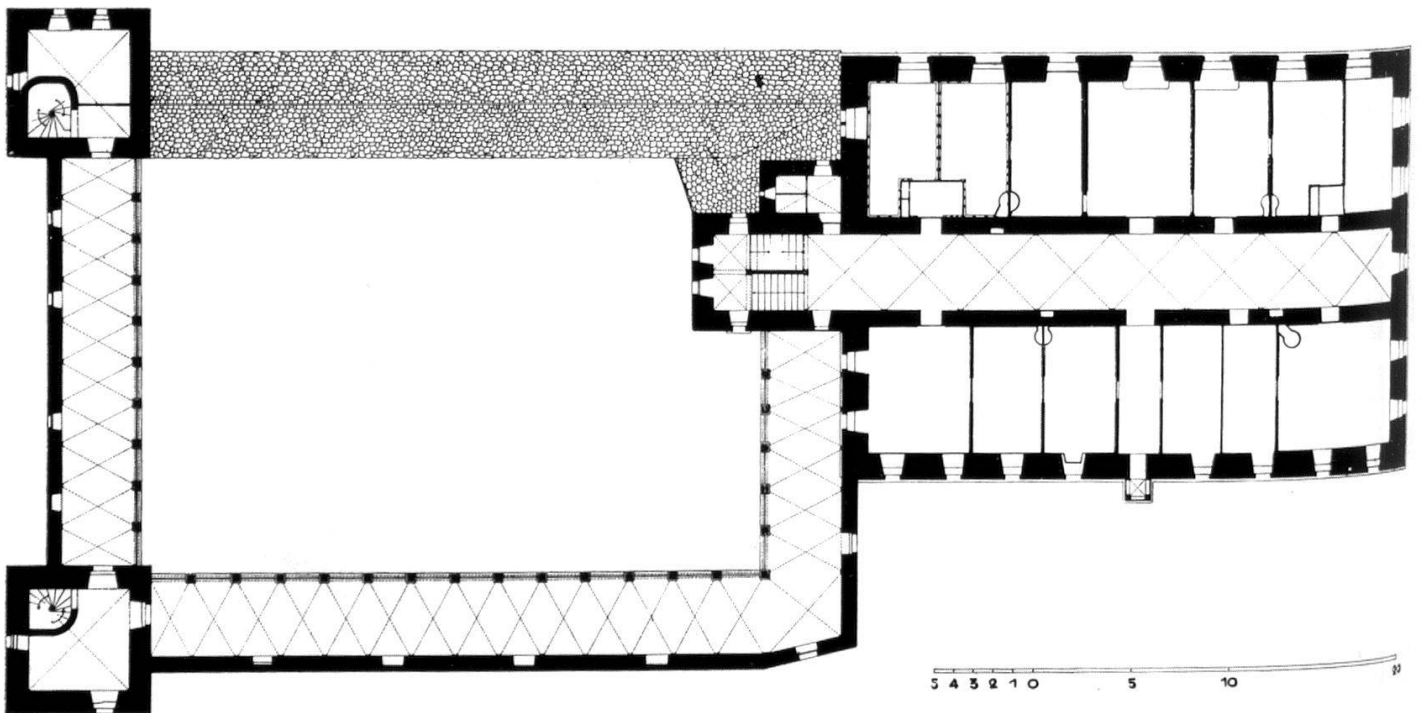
Brig, Schloß Stockalper, Grundriß, 2. Stock
